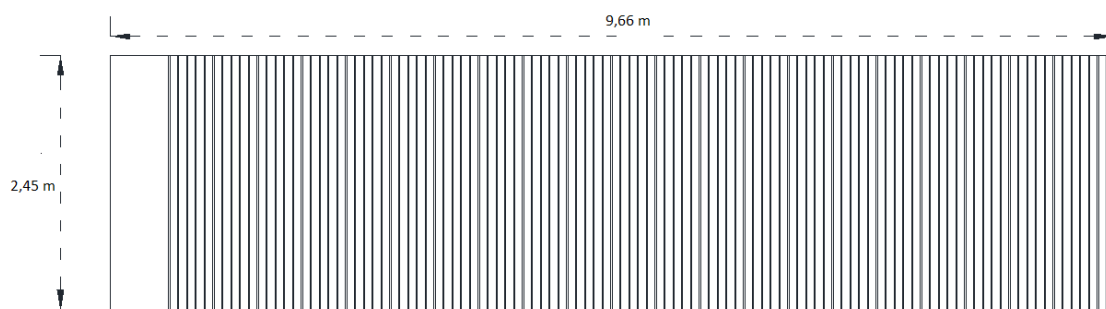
Diseño de sedimentador 1 y 2 de alta tasa. Vista en planta
